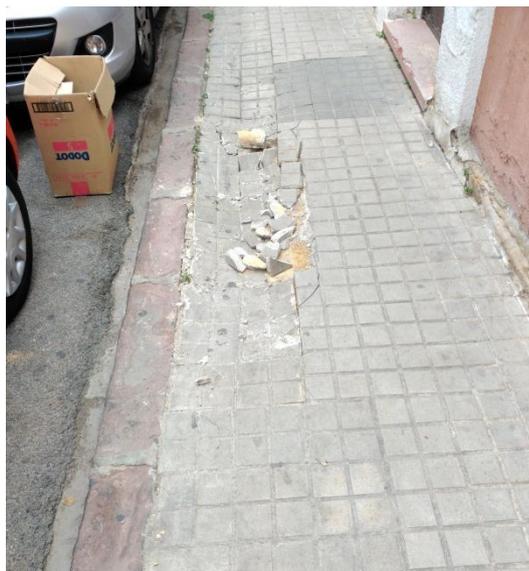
Pavimento acera en mal estado en la calle El Salvador
